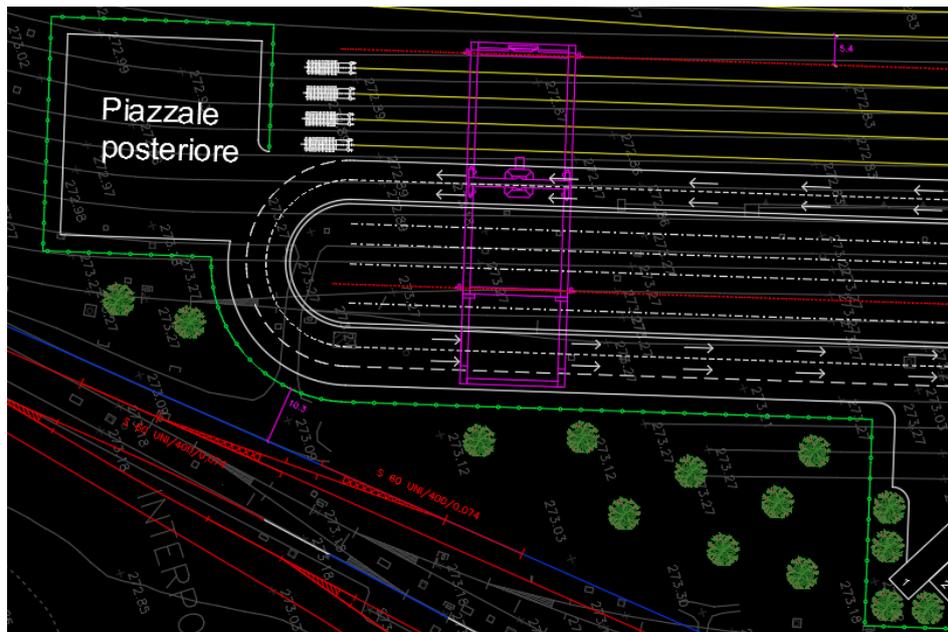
Estratto Autocad settore posteriore del terminal gateway
